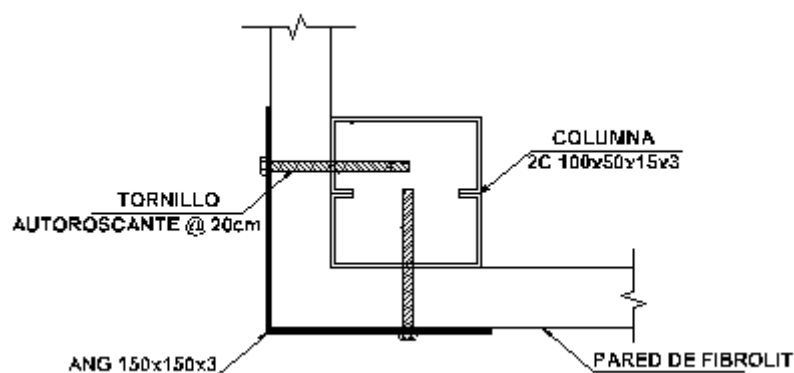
Unión del Fibrolit a las columnas de acero.
